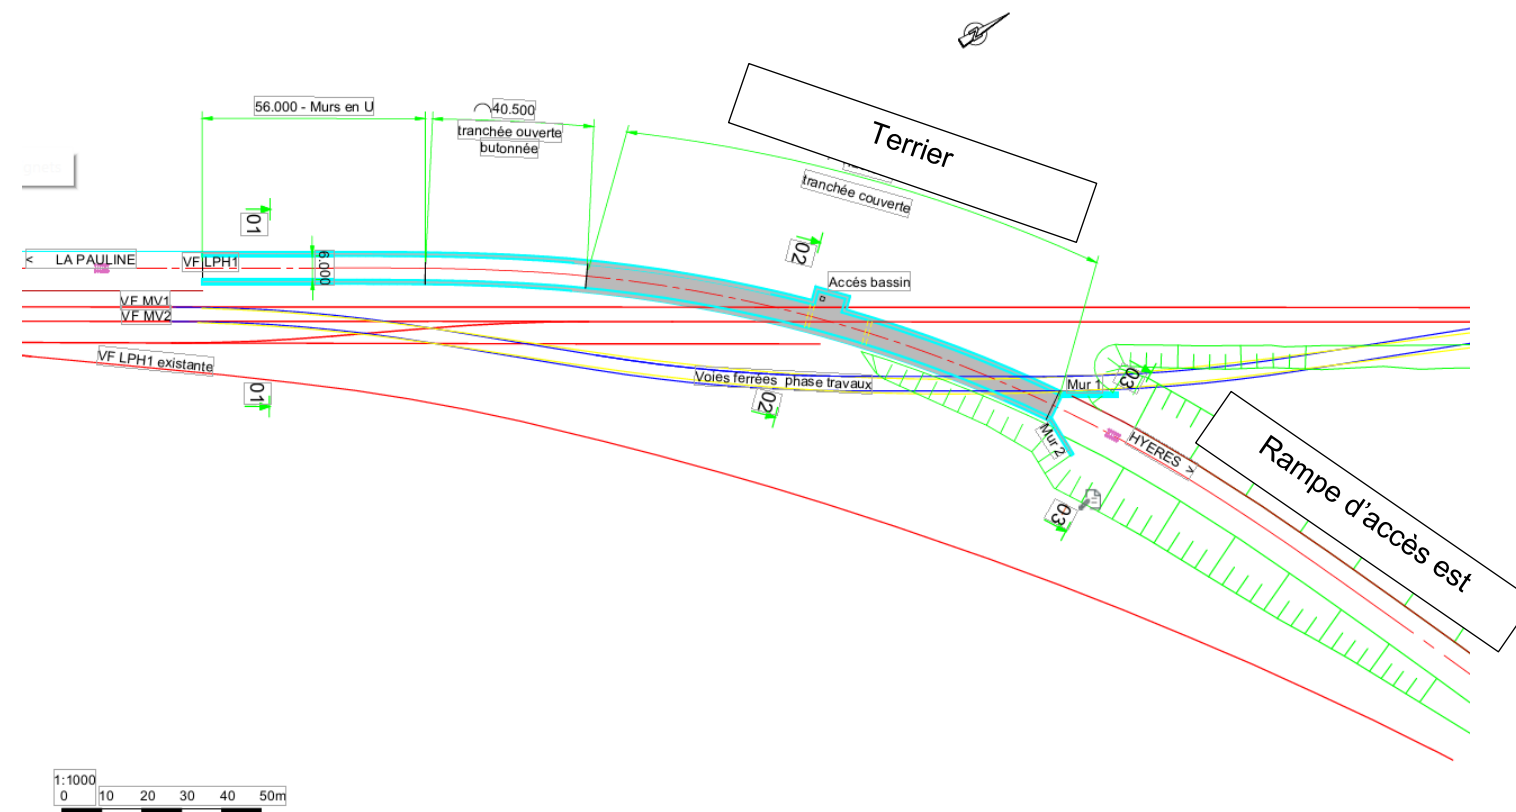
Vue en plan du terrier et des rampes d'accès (source : Egis, 2021)
